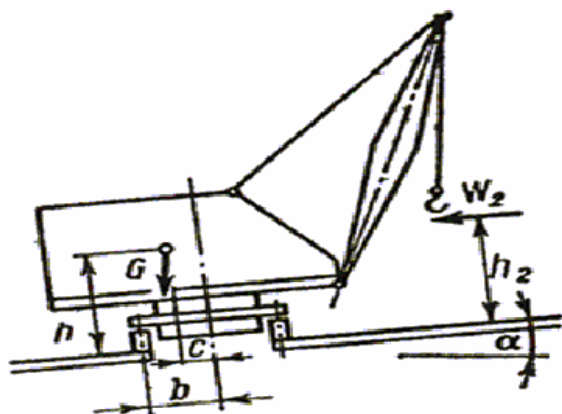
Расчетная схема собственной устойчивости самоходного крана
